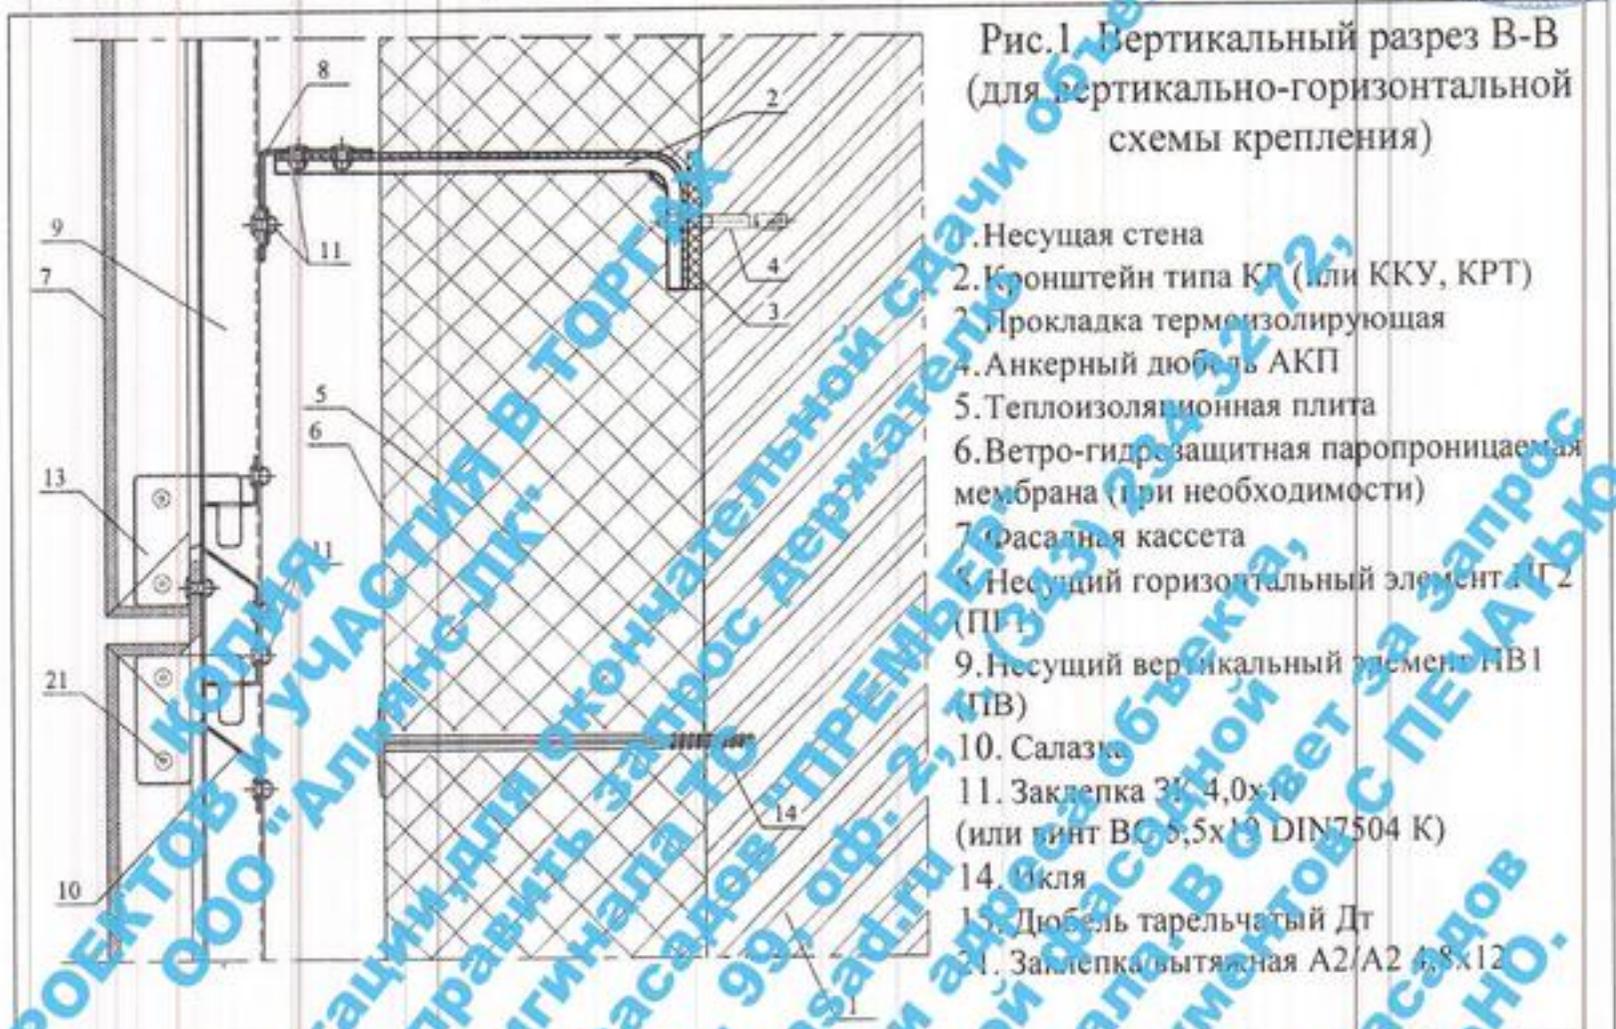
Вертикальный разрез В-В (для вертикально-горизонтальной схемы крепления)
